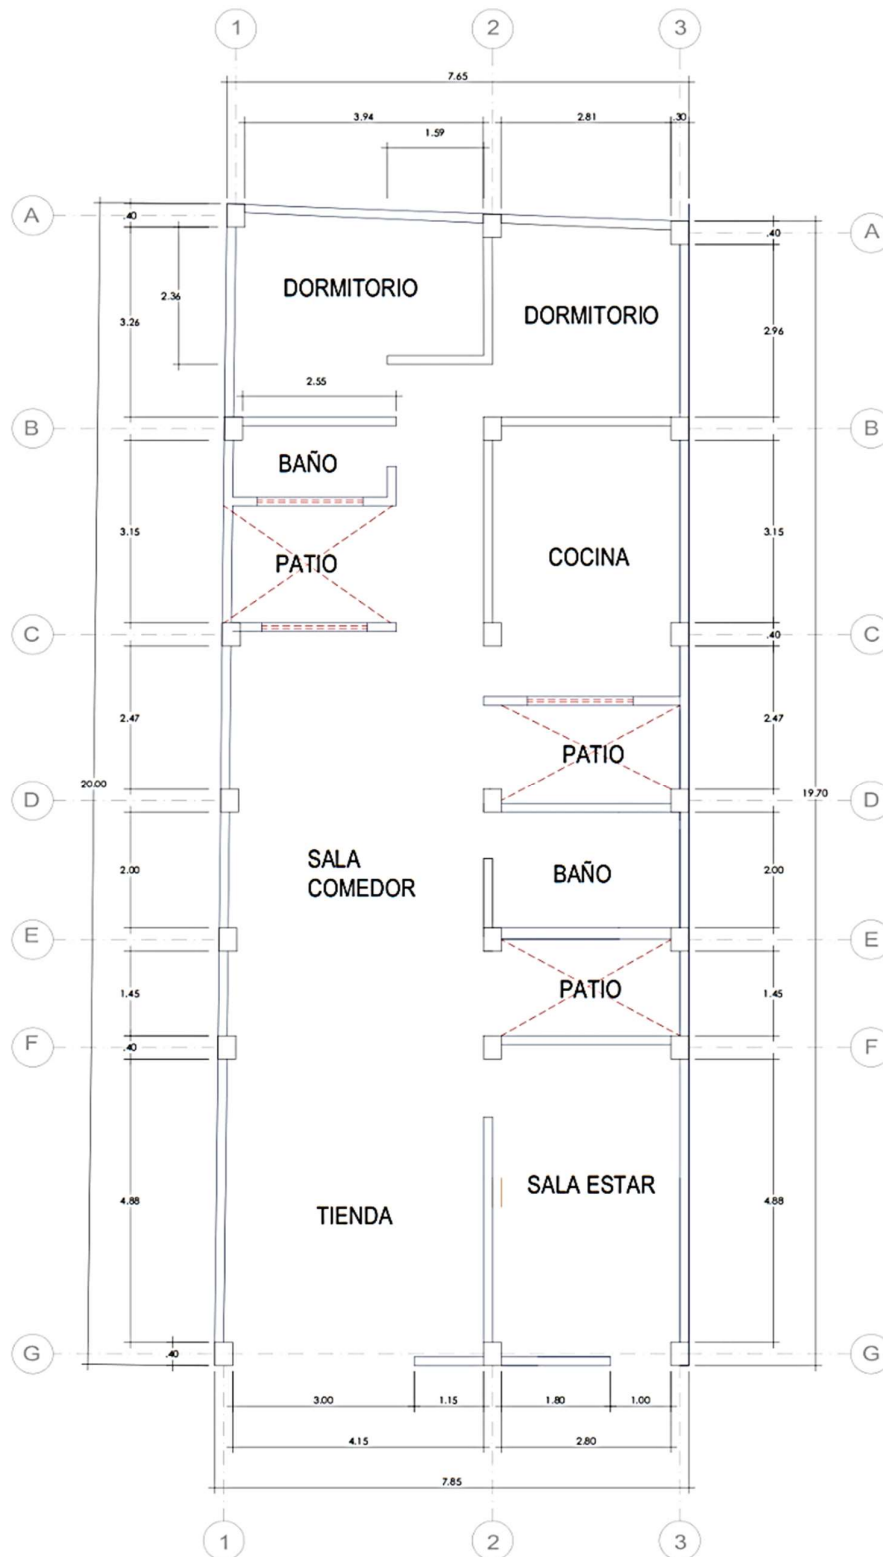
Configuración Geométrica en planta de la vivienda N°01
